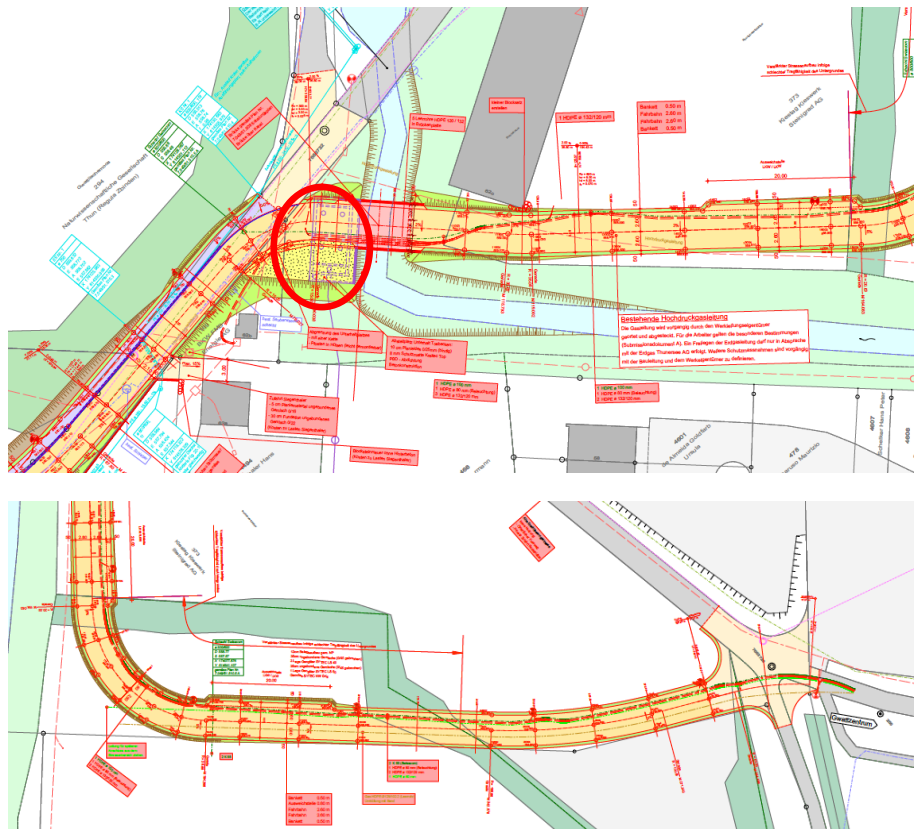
Situationsplan Bauprojekt der neuen Erschliessungsstrasse Gwatt mit Tosbecken vor der Brücke (rot markiert)
